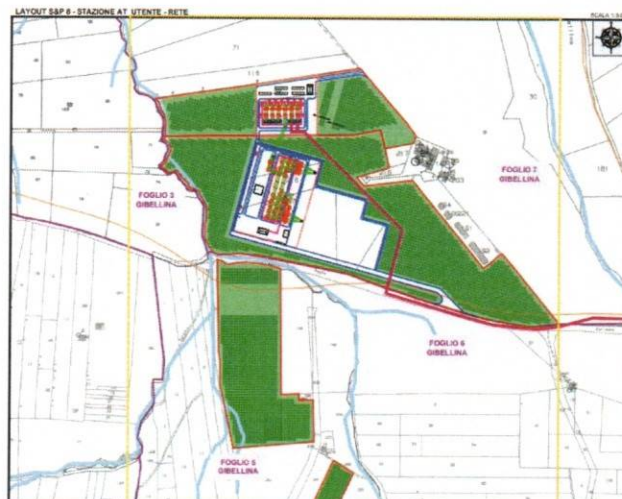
Elaborato di progetto “stazione AT utente rete”
